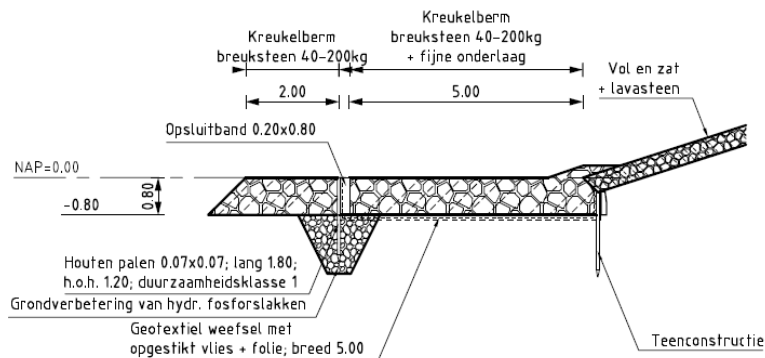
; asfaltsluiting kreukelberm met opening tegen waterdruk
